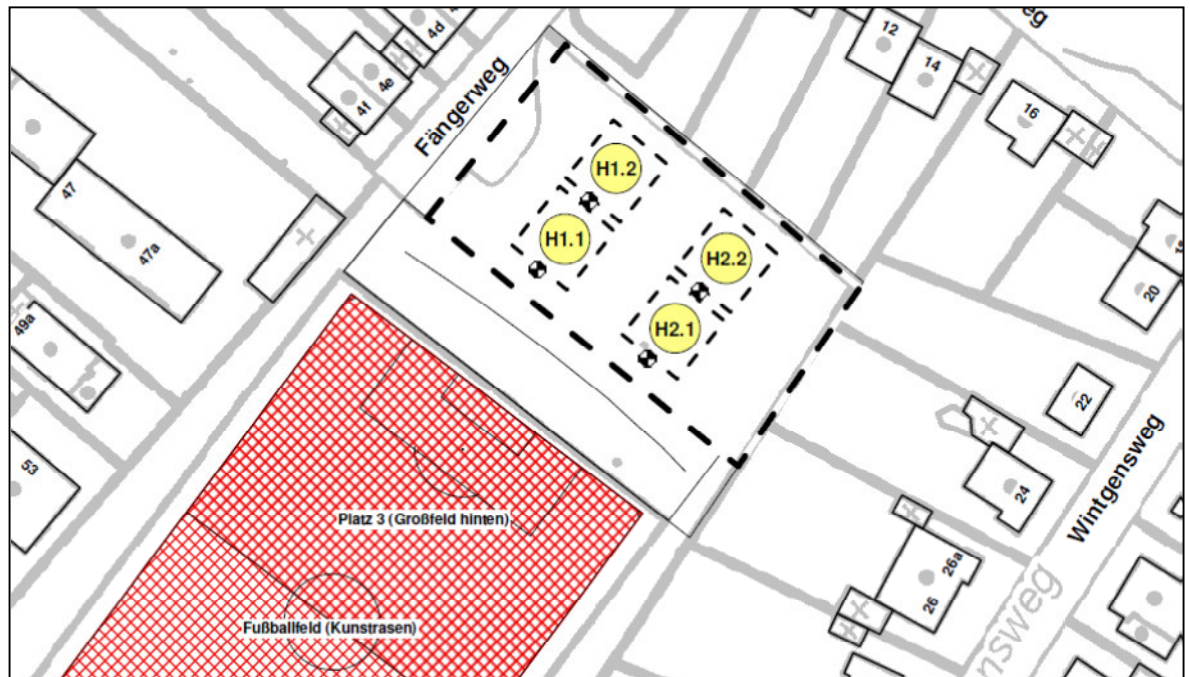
Ausschnitt aus dem Lageplan in Anlage 3 zur Darstellung der berücksichtigten Positionen der geplanten Doppelhäuser, Pos. 1 Richtung Sportplatz, Pos. 2 Richtung benachb. Gärten
